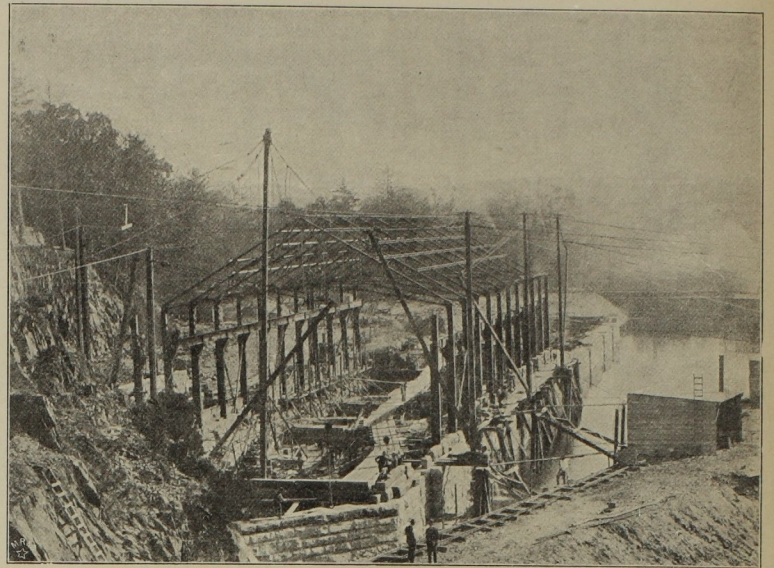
Bau des Maschinenhauses für die Turbinen- und Pumpen-Anlage.
